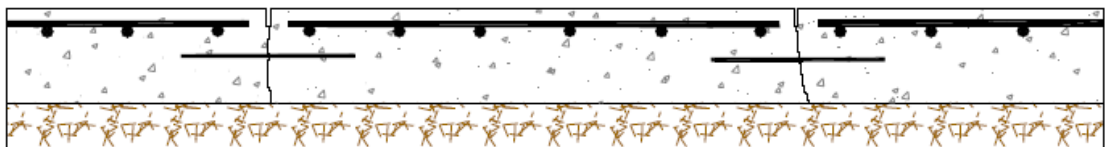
B. Sección Longitudinal de un JRCP.
